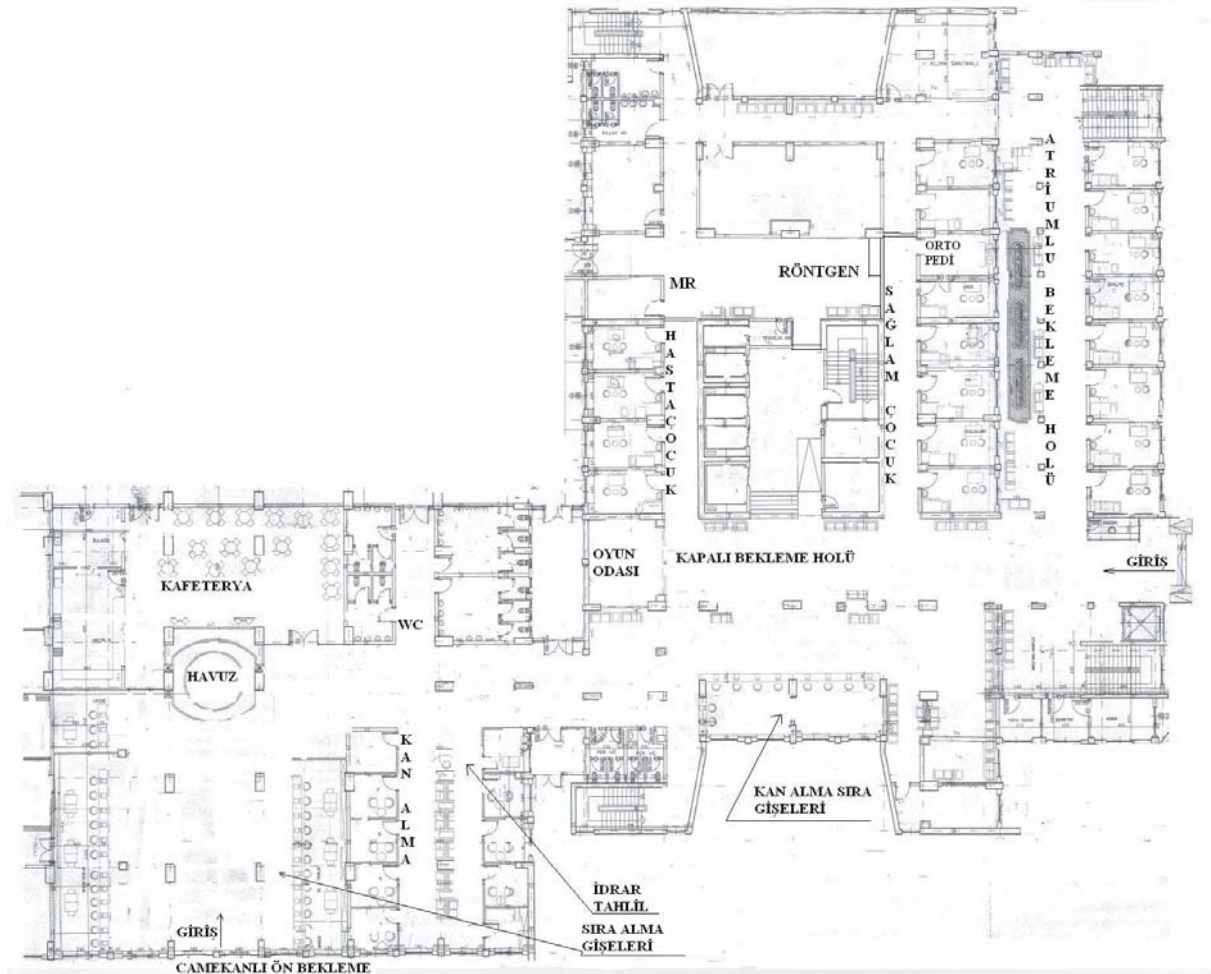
Gazi Hastanesi vaziyet planı (24)
